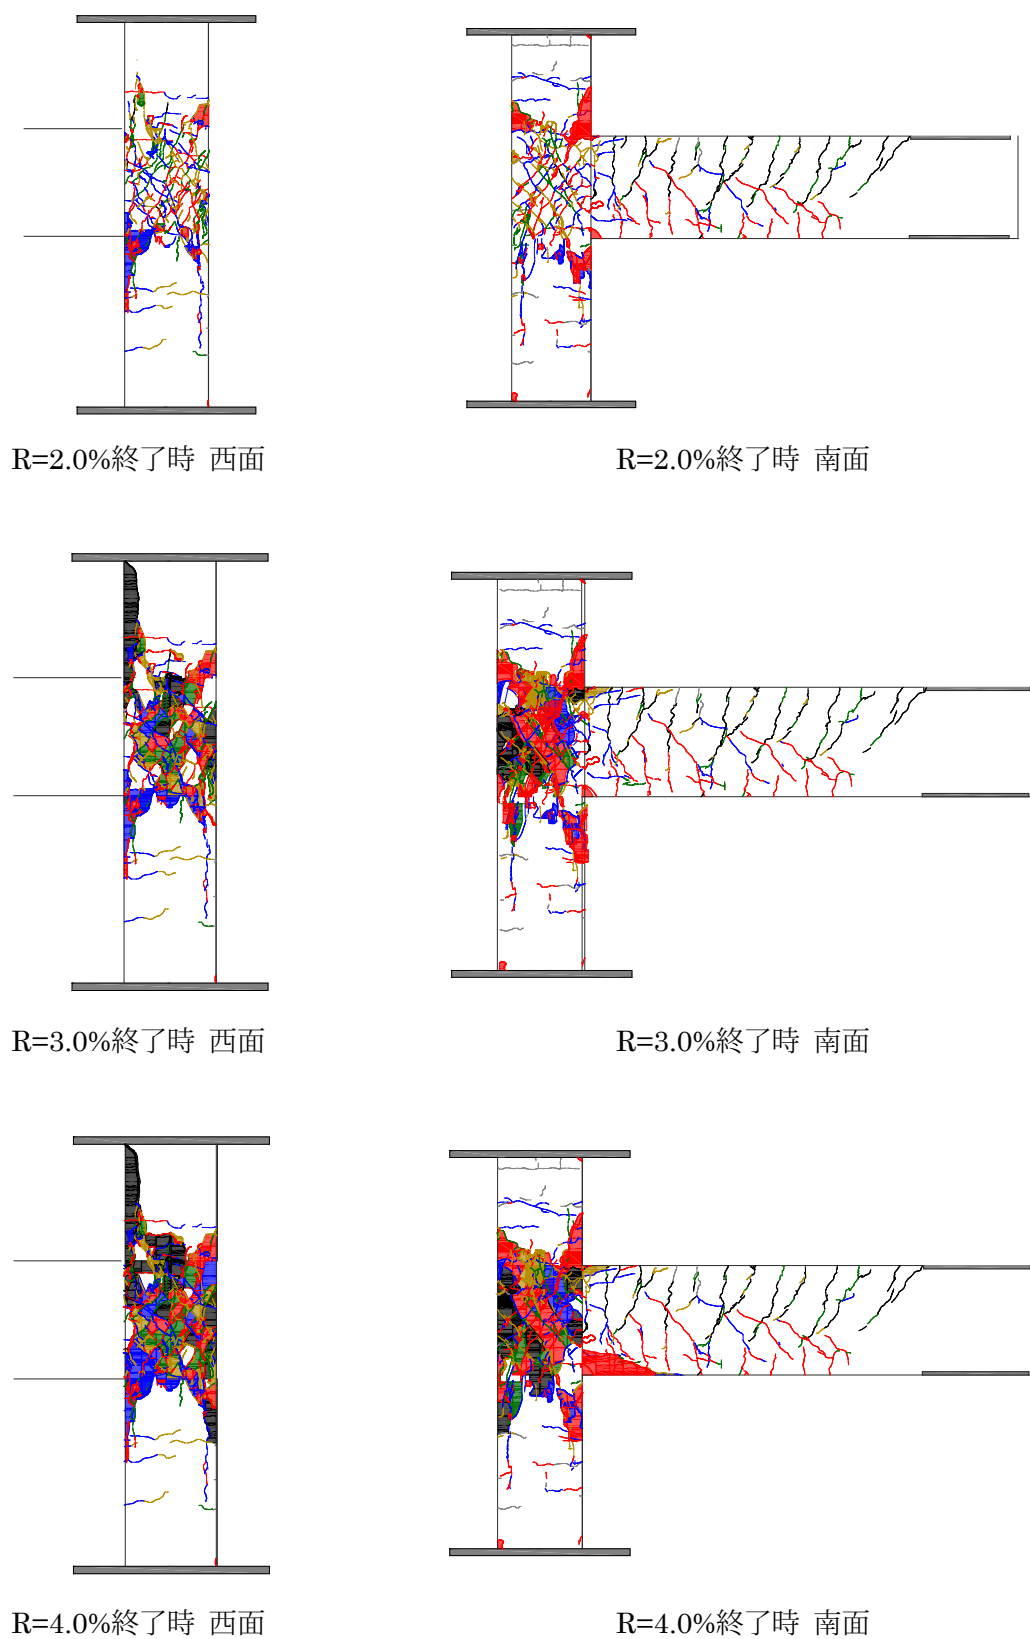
(d) ひび割れ状況 (試験体 F4)
